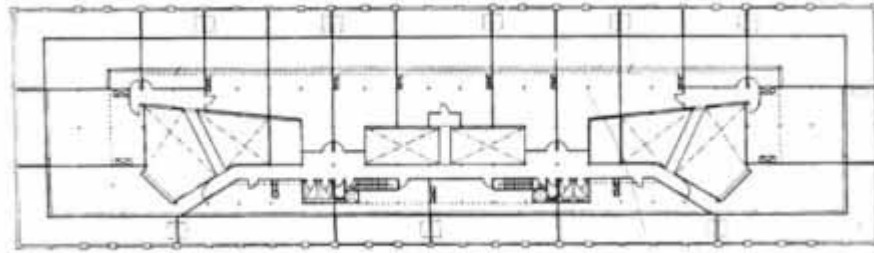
planta 4º pavimento do Galpão 5, onde se distribuem as unidades habitacionais duplex. Fonte: Revista Arquis nº 1.
